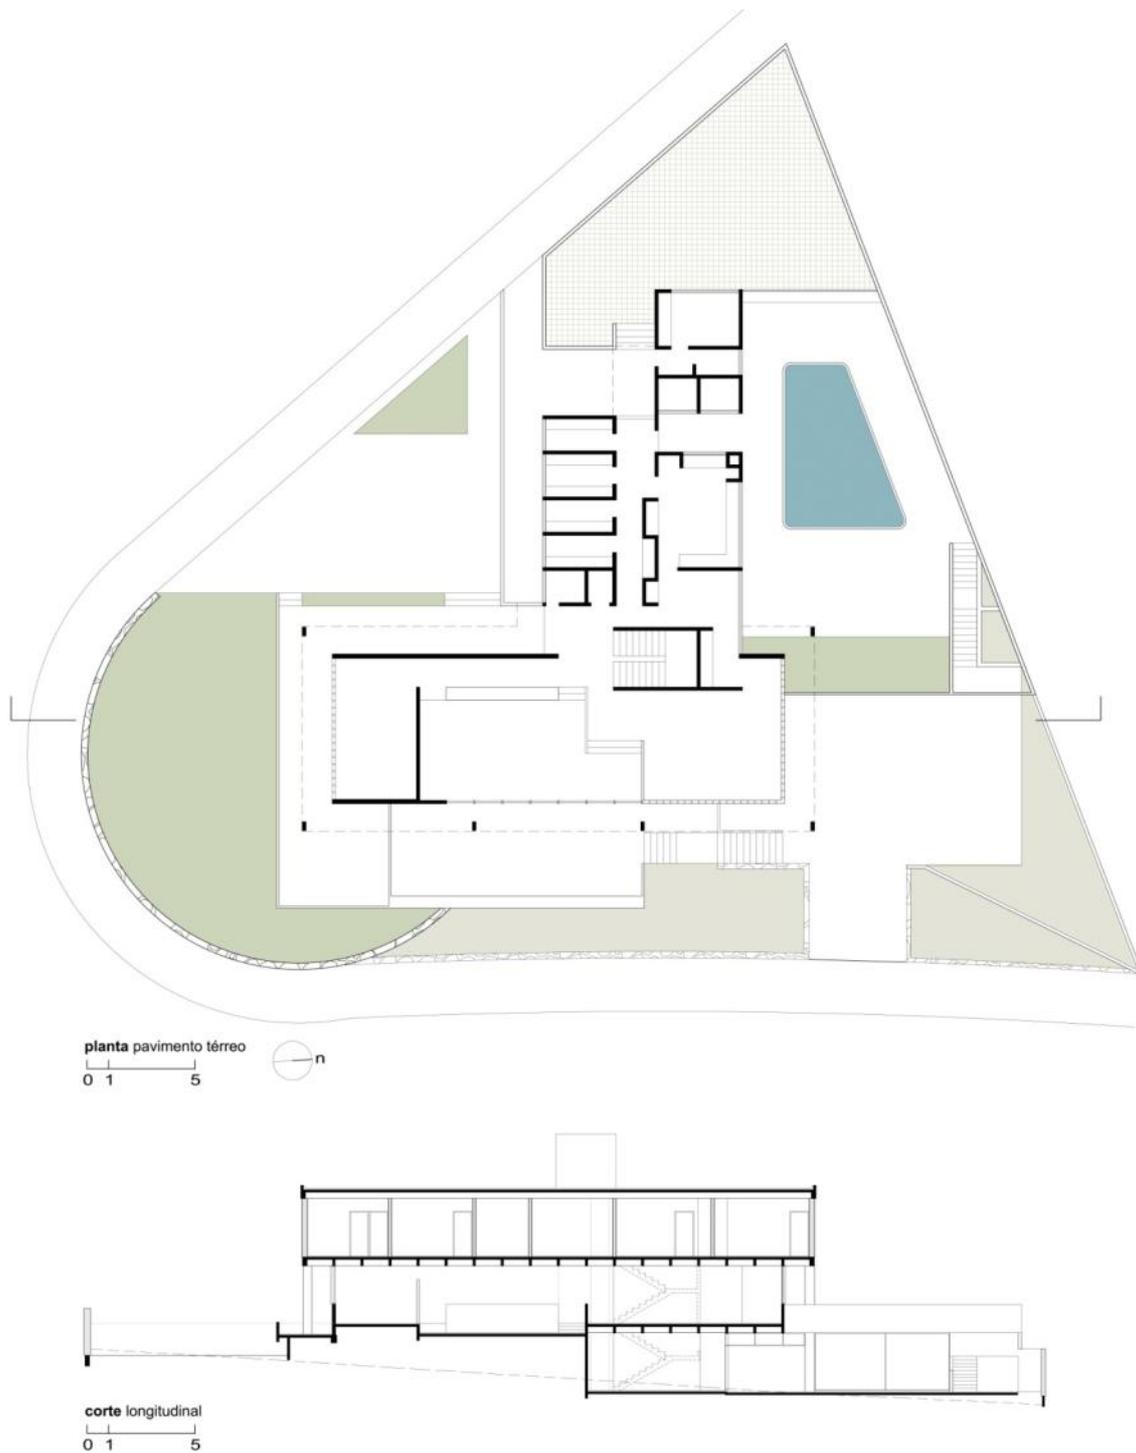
Residência De La Torre. Planta do pavimento térreo e corte longitudinal. Fonte: Redesenho do autor sobre originais do acervo Gilberto Pascoal.
